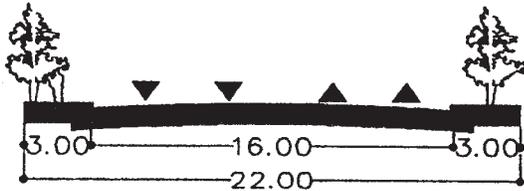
Detalle Sección Vial Camino Ortiz Rubio.
